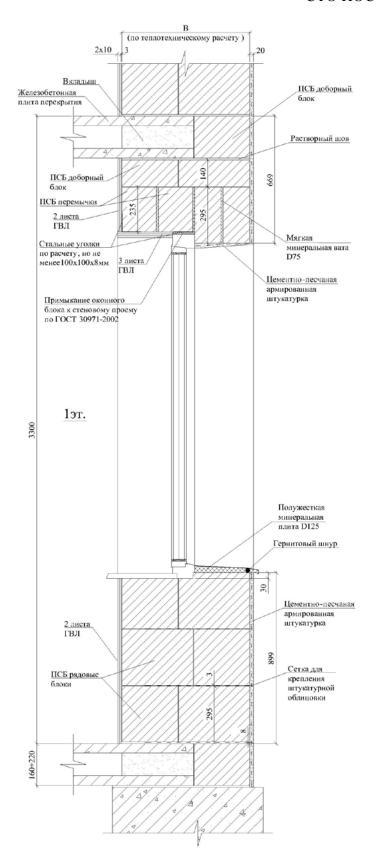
Несущая стена из полистиролбетонных блоков с фасадной штукатуркой. Вертикальный разрез по оконному проему
